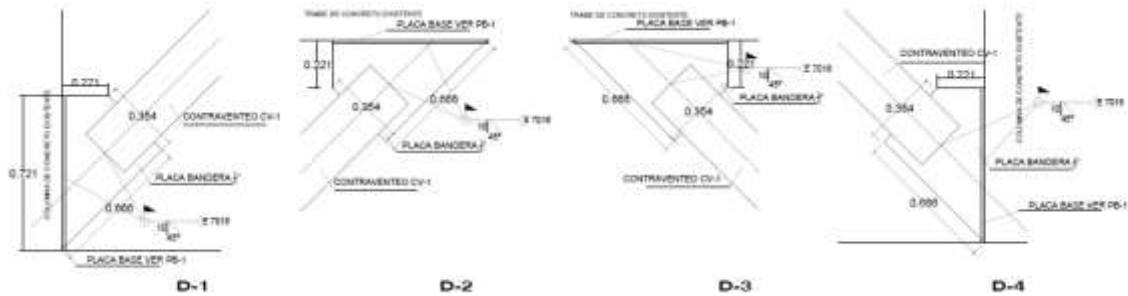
Detalles de conexión contraventeos, Proyecto Estructural.
